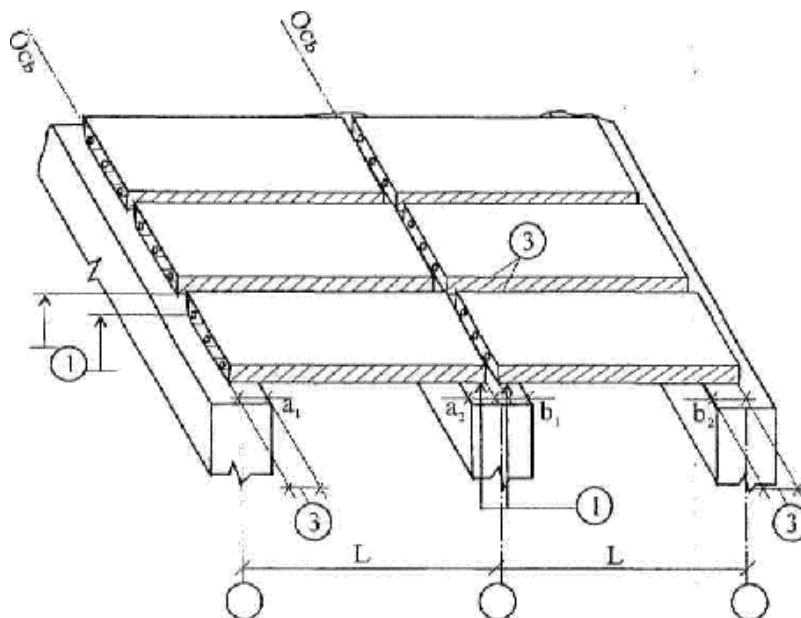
Допустимі відхилення при монтажі залізобетонних конструкцій будівель
